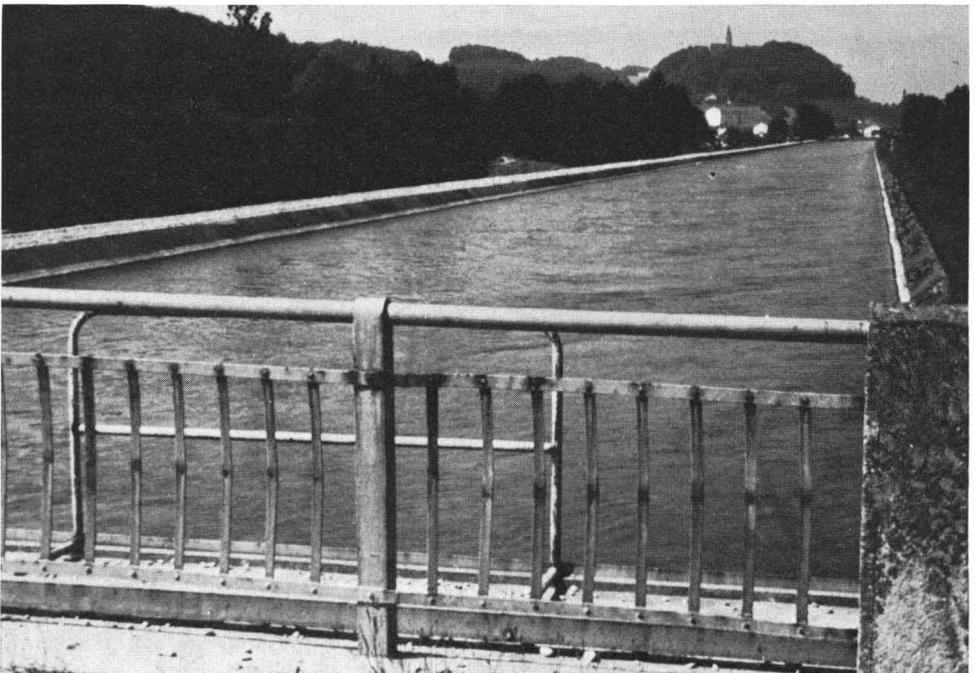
Eingezwängt in eine Betonrinne fließt das Alzwasser dem nächsten Kraftwerk entgegen. „Rehfalle“ wird der Kanal mit seinen steilen Betonwänden genannt.
